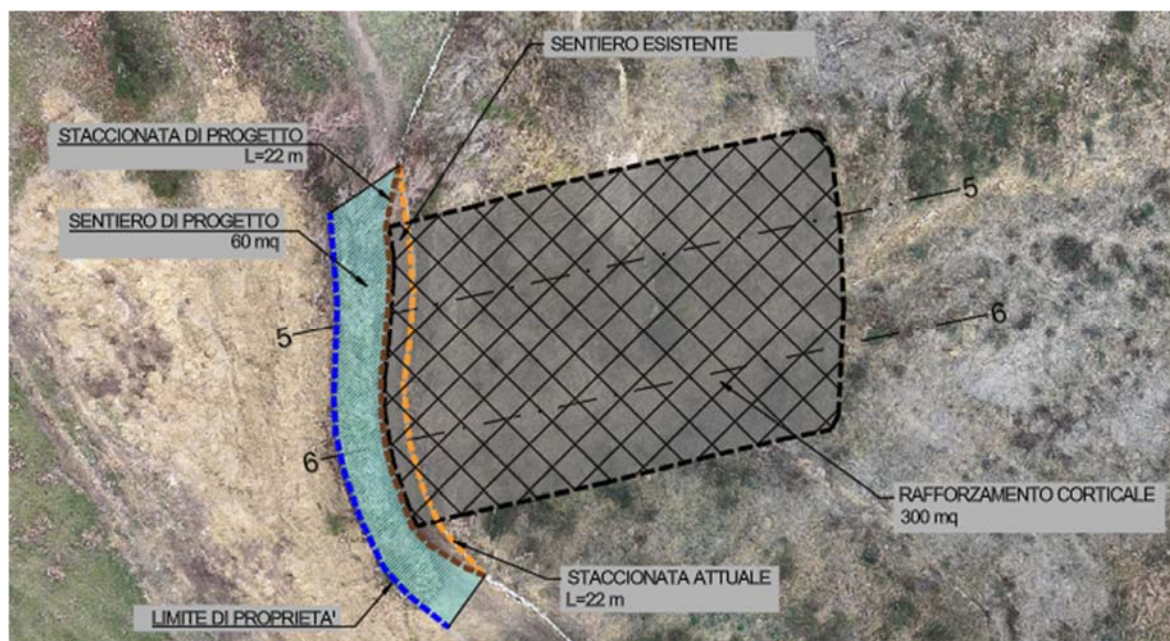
Rafforzamento corticale - ubicazione dell'intervento di
